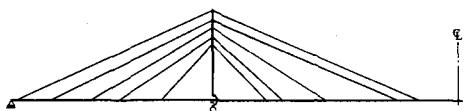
A ケーブル配置、塔高および各部材要素の断面寸法を設計変数とした最適化(STEP-1)
